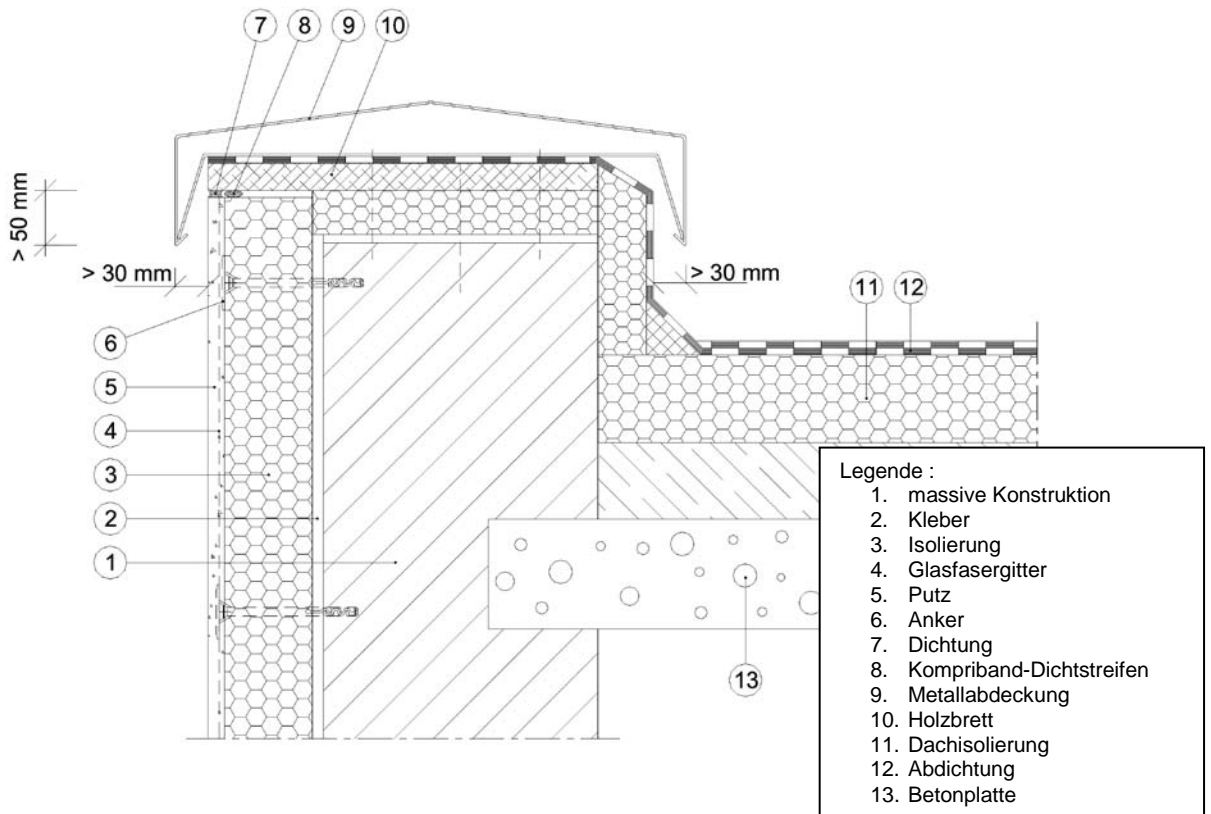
Bauliche Durchbildung einer Flachdacheinfassung mit Metallabdeckung
